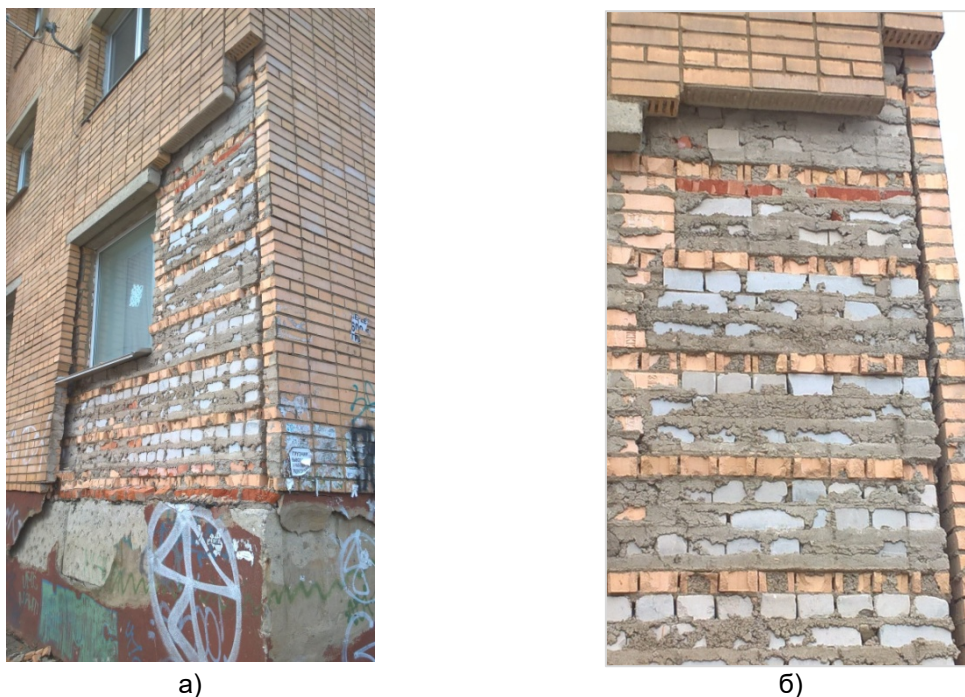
Обрушение фрагмента лицевой кирпичной кладки наружных стен жилого здания в Смоленске: а - общий вид; б - фрагмент фасада
